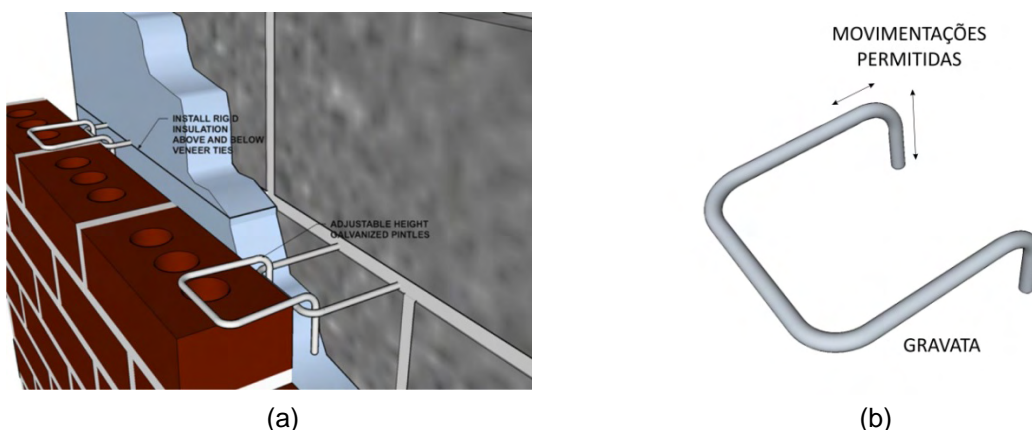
Sistema *Cavity Wall/Brick veneer/Reinforced Concrete Block*.
